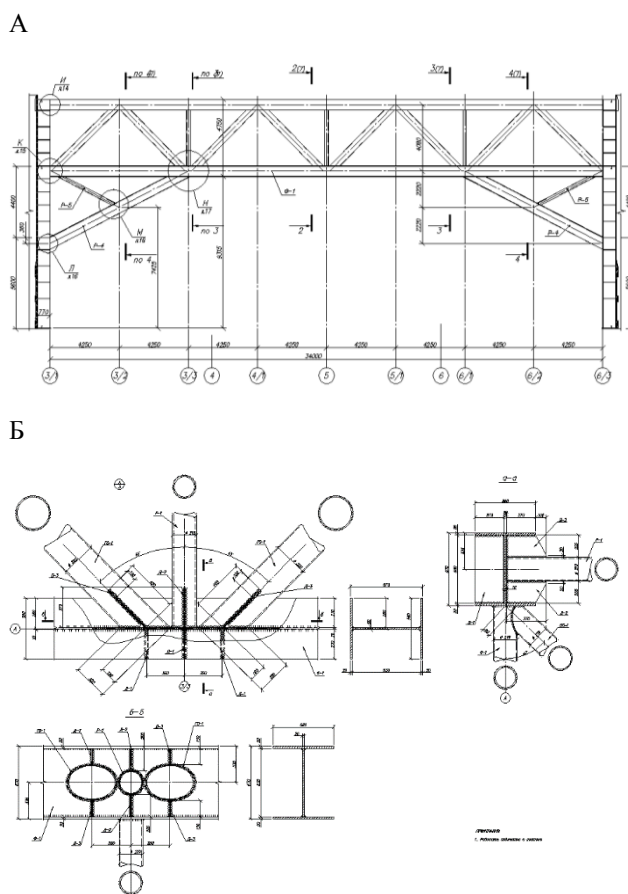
Конструктивное решение стальной укрупнительной рамы. А - вид поперечной вертикальной несущей фермы; Б - решение узлов сопряжения связей с элементами фермы
